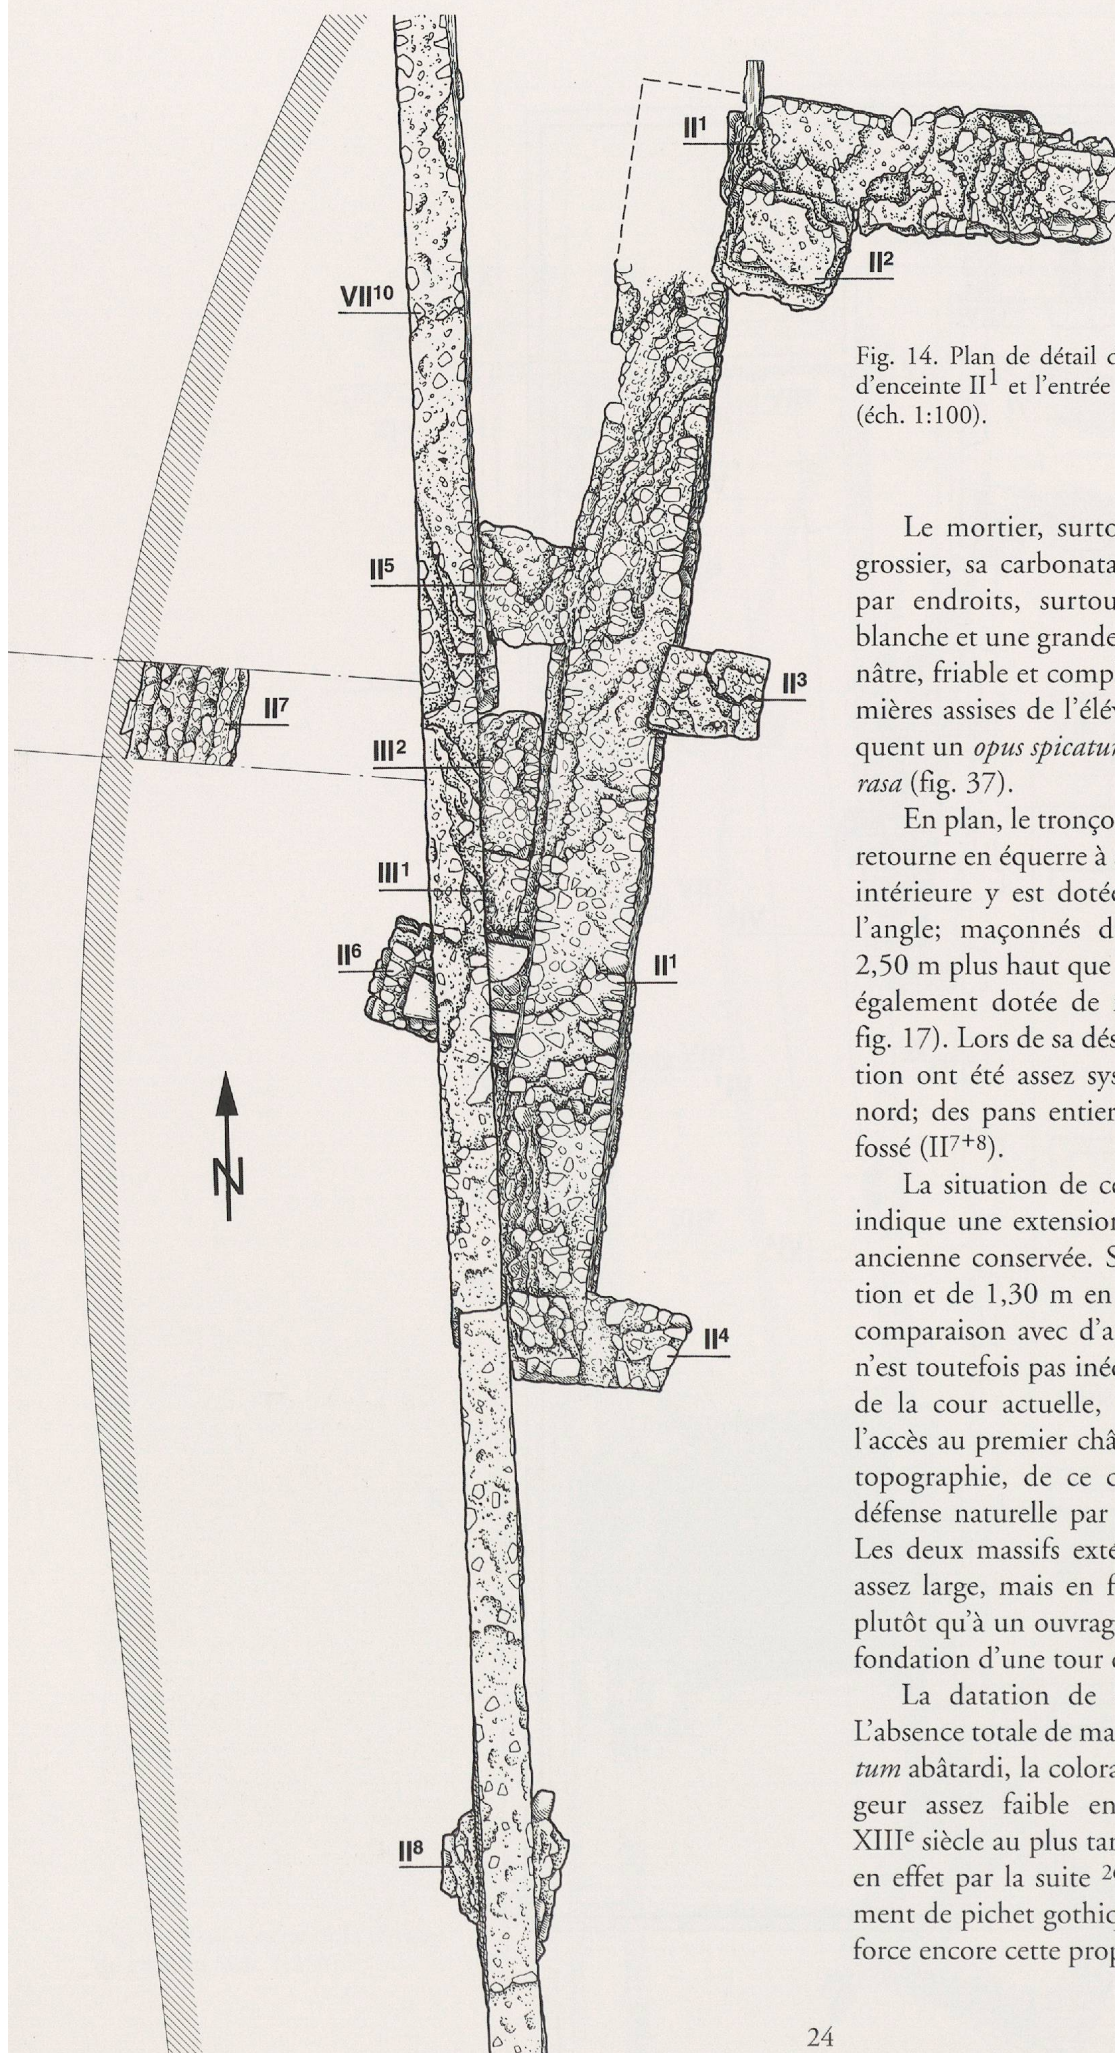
Plan de détail de la terrasse ouest, avec le premier mur d'enceinte II¹ et l'entrée primitive au sud du massif d'ancrage II⁴ (éch. 1:100).
